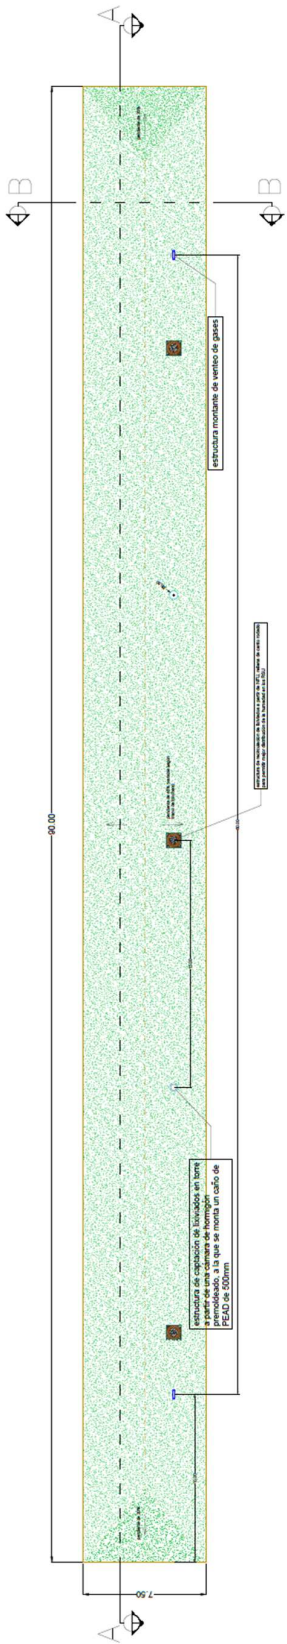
| Planta de la trinchera tipo terminada. Elaboración propia
